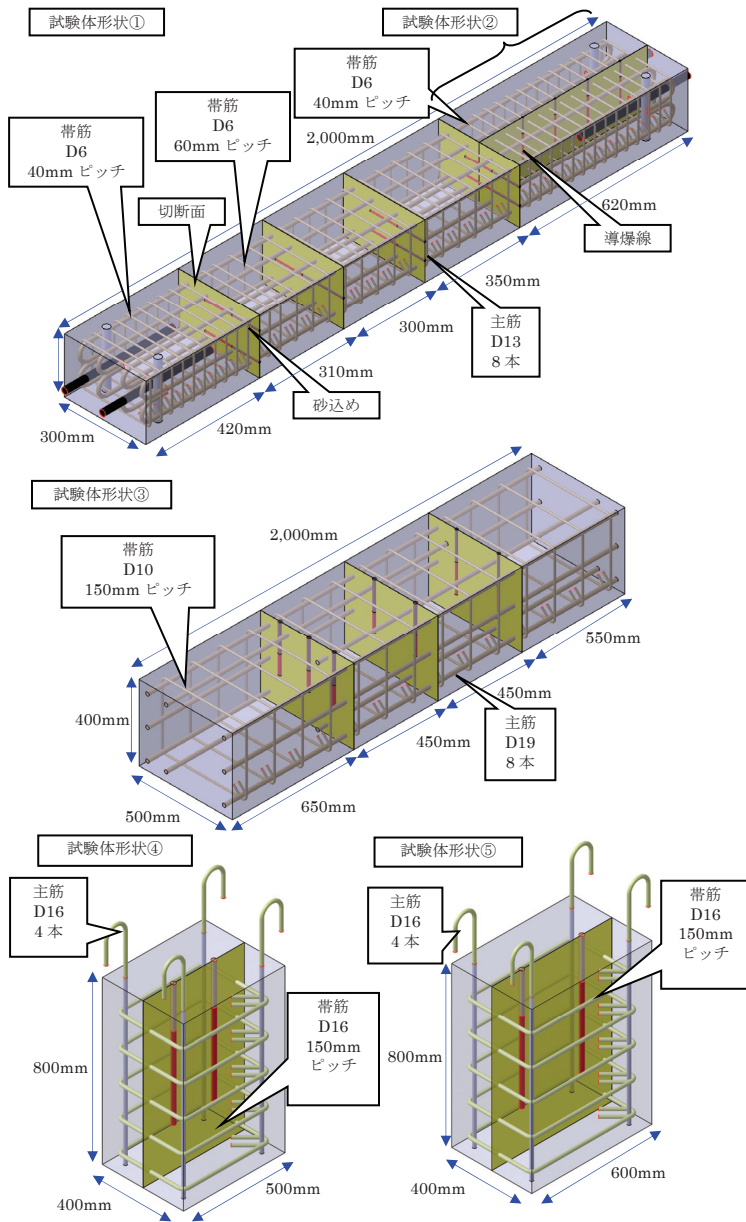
有筋コンクリートの試験体 (Specimens of Reinforced Concrete)
